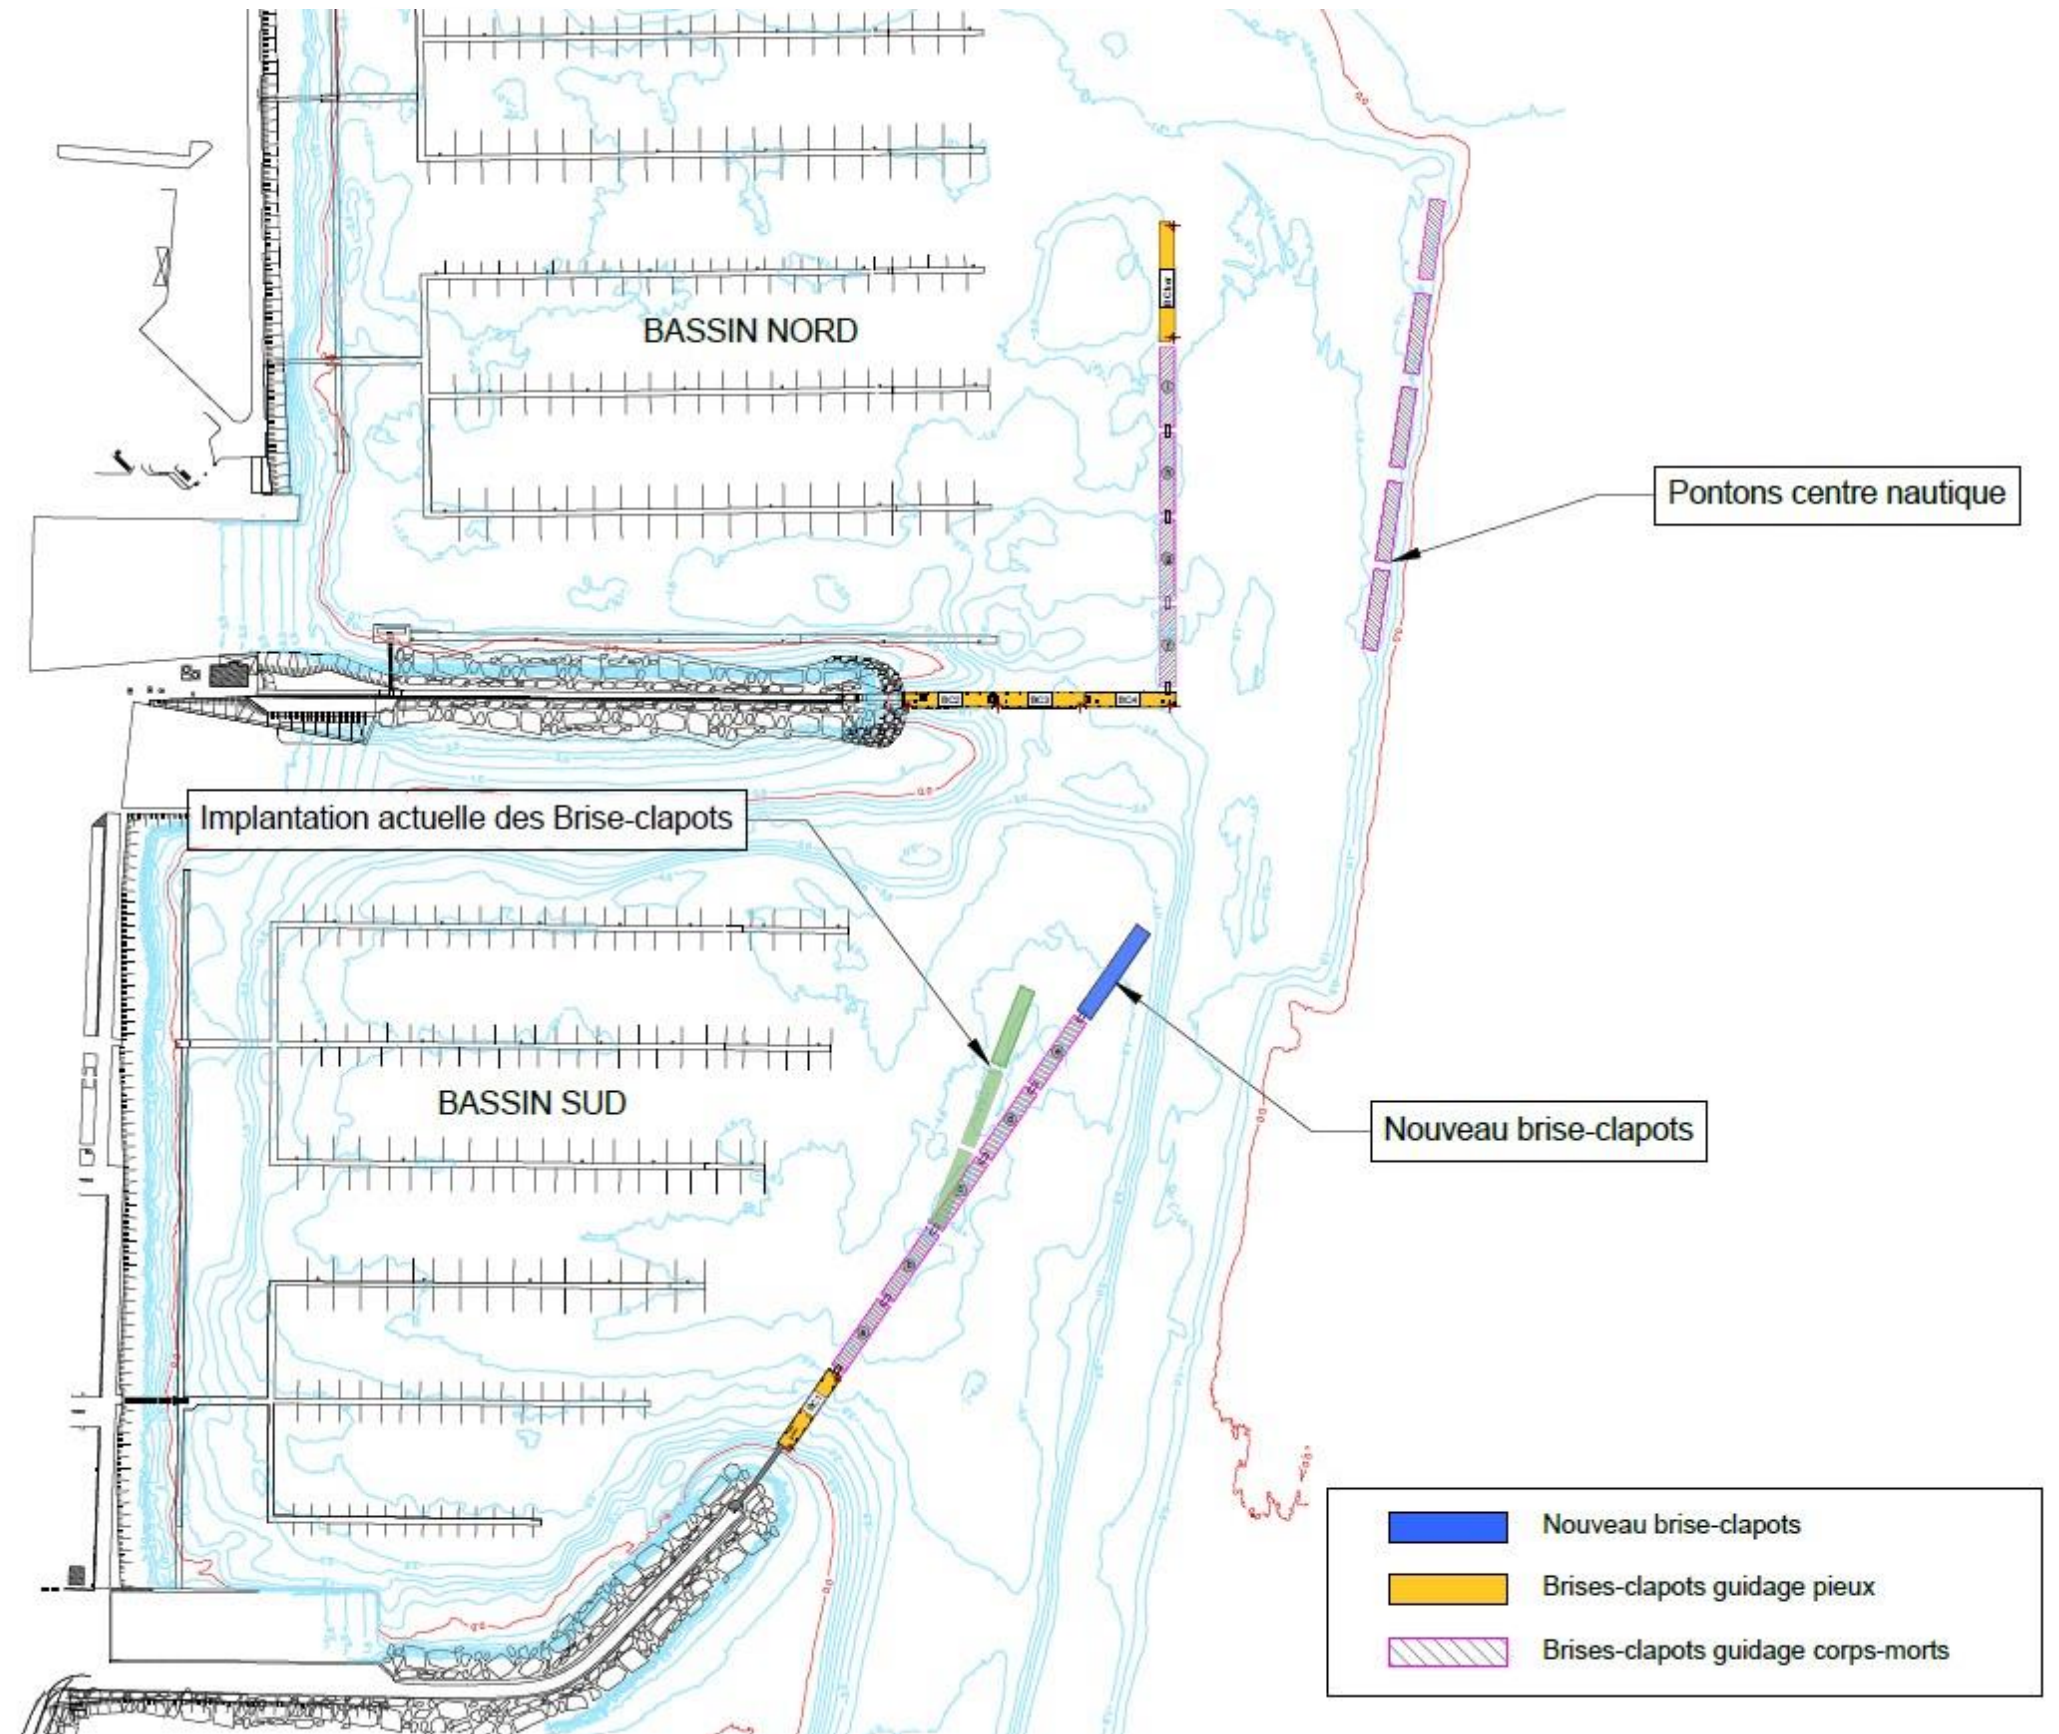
Plan masse du projet (source : Ingérop, mai 2023)
